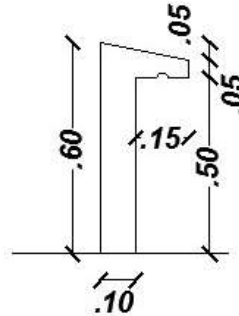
Dimension de l'acrotère type 2 (Terrasse inaccessible)
